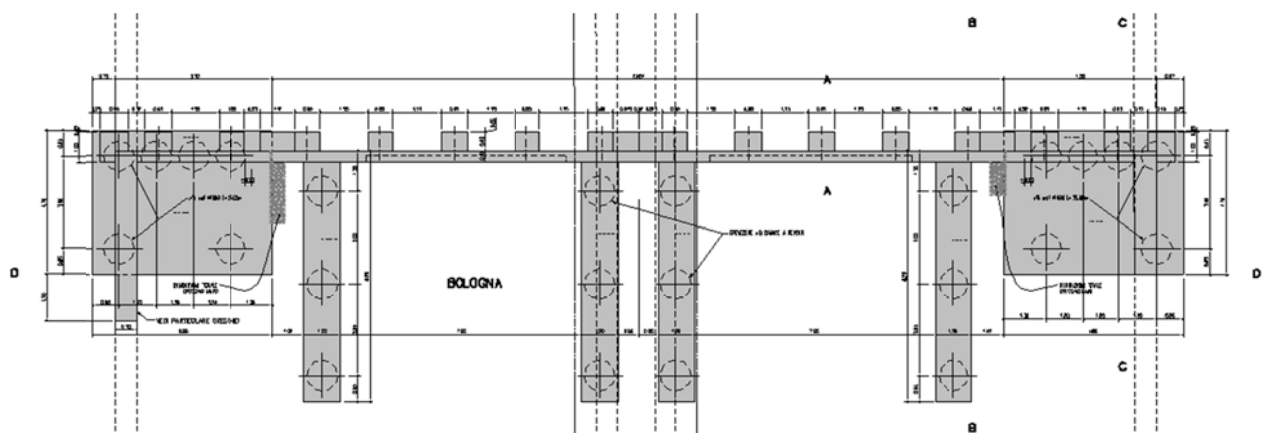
Pianta con localizzazione tiranti a tergo spalla
